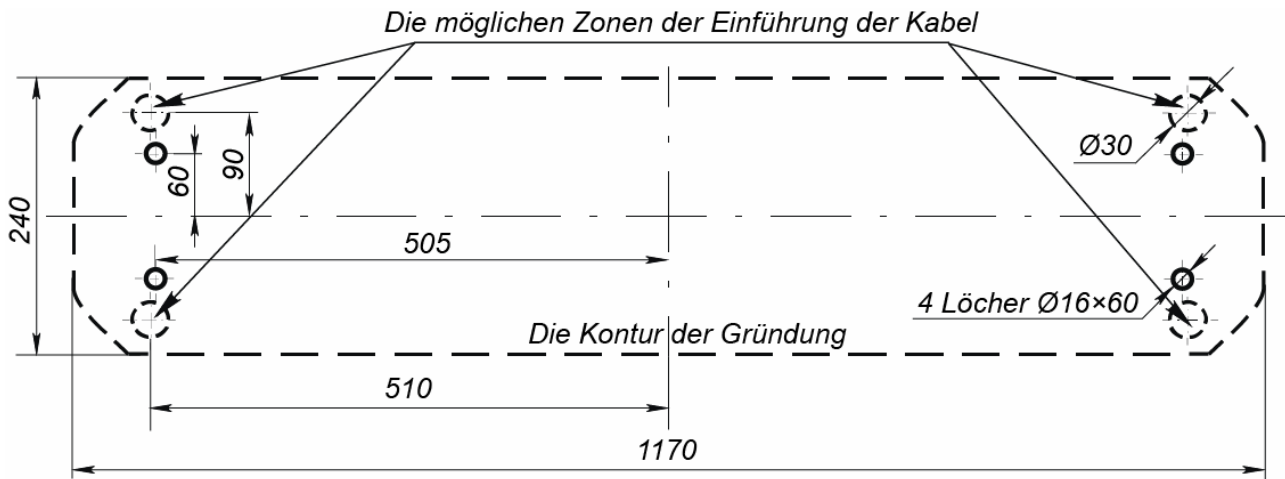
Das Schema der Markierung für die Montage des Drehkreuzfußes
